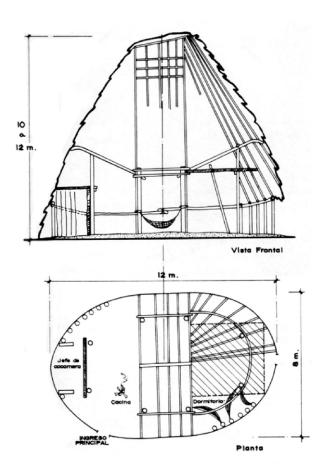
Planta y vista frontal de la cocamera. Ferruccio Marussi. 2004.
